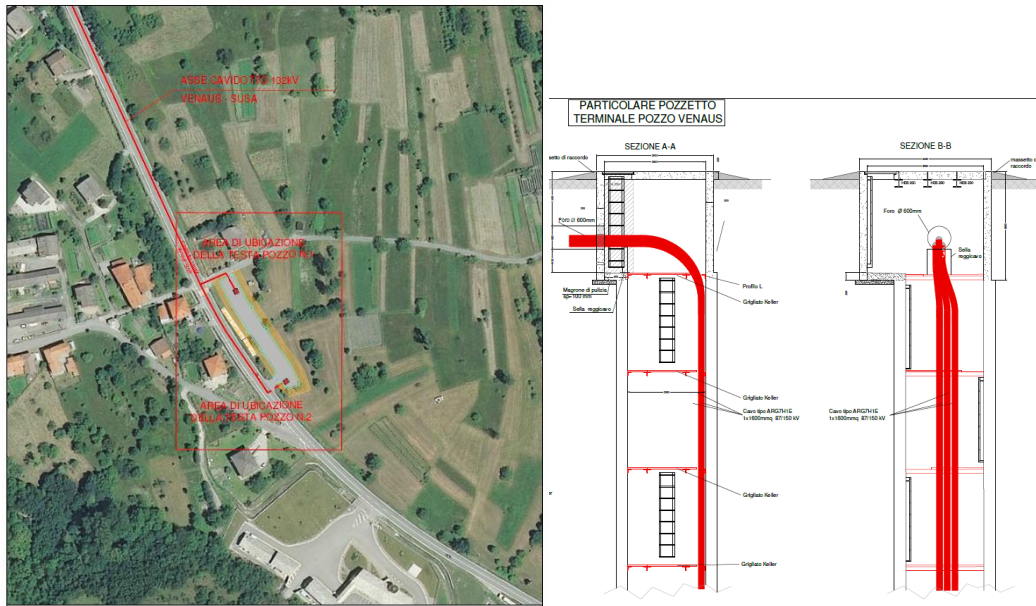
Ubicazione dei manufatti di testa dei pozzi di collegamento – Sezione tipologica pozzo cavidotto Venaus
